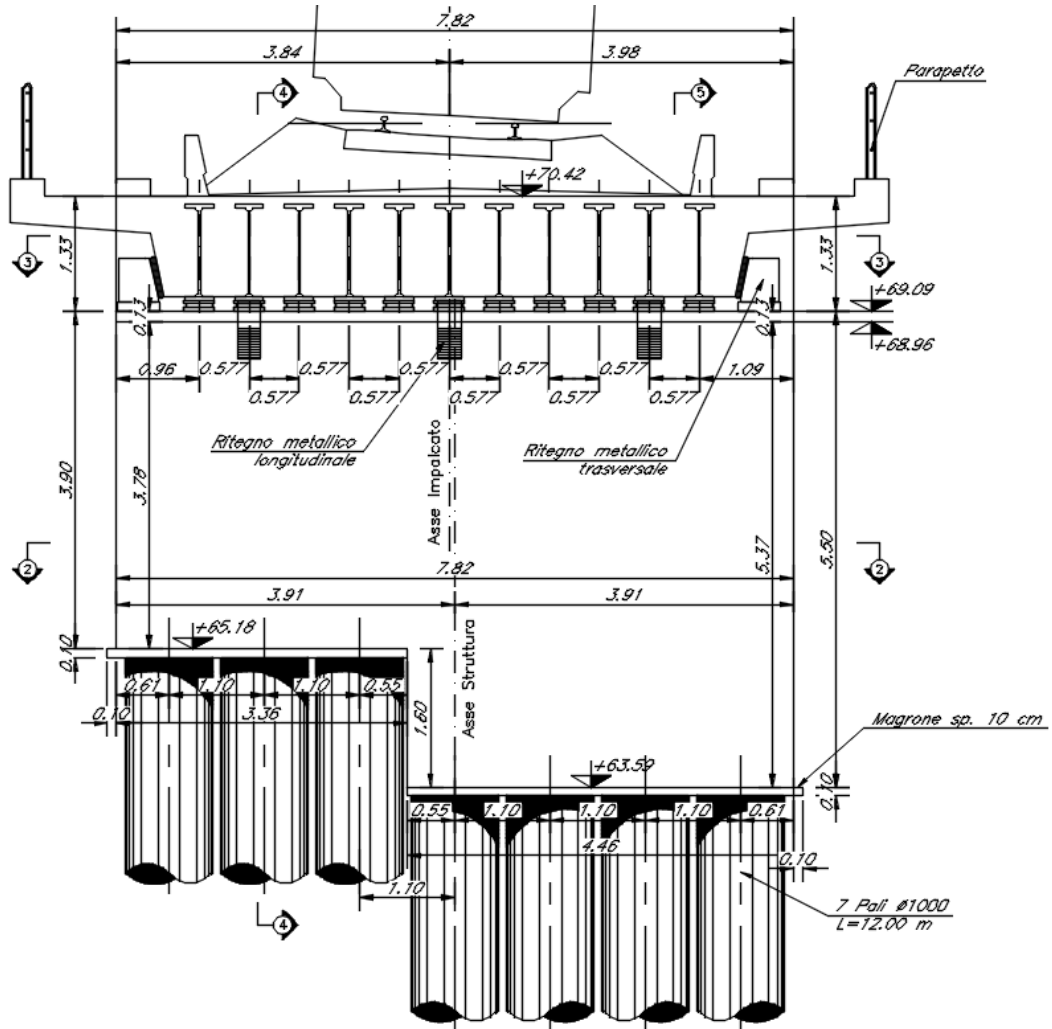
Spalla P1 (spalla con appoggi "mobili") - Sezione trasversale 1-1
